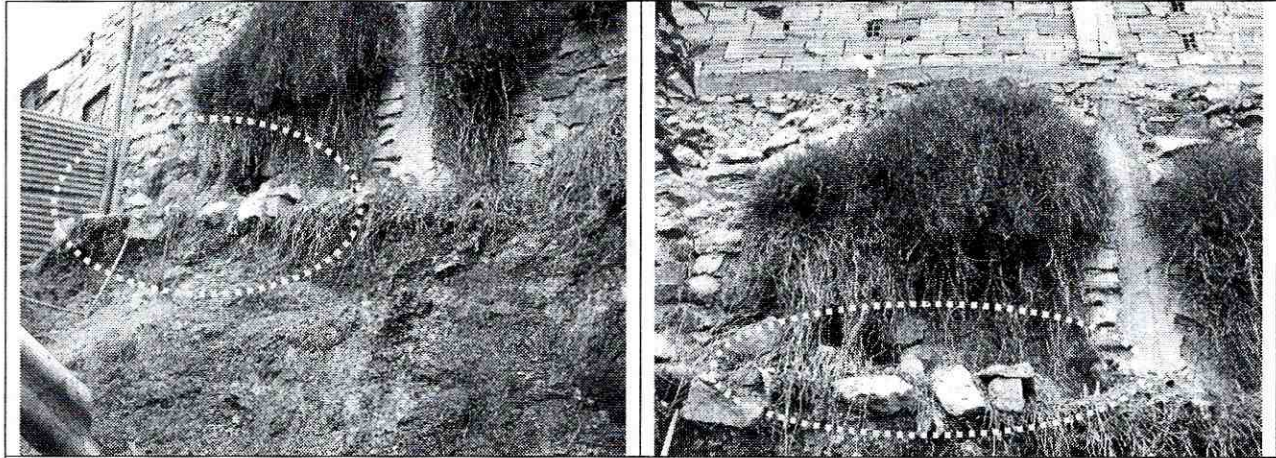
y 4. Muro de piedra pegada que pertenece a la vivienda de la Calle 82 Sur # 44A -31, ubicado hacia la parte posterior de la vivienda de la Calle 82A Sur # 44A - 32, se observan antiguos desprendimientos de los elementos que conforman este muro
